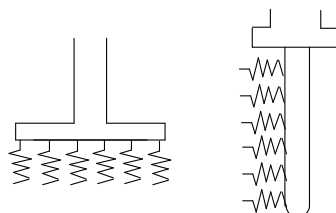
Sur semelle ou sur pieux, une fondation a une certaine rigidité  $k_{sol}$
